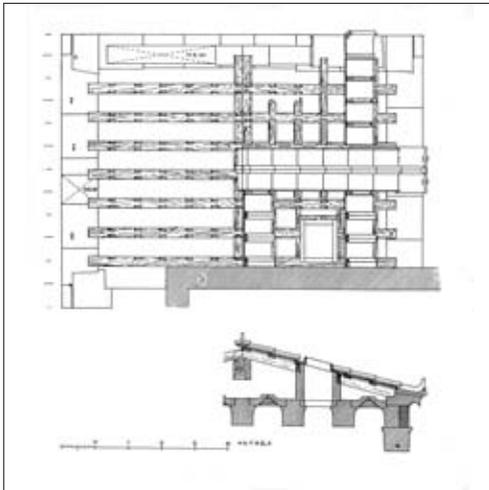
Eretheo. Portico nord. Pianta e sezione di ricostruzione del tetto
